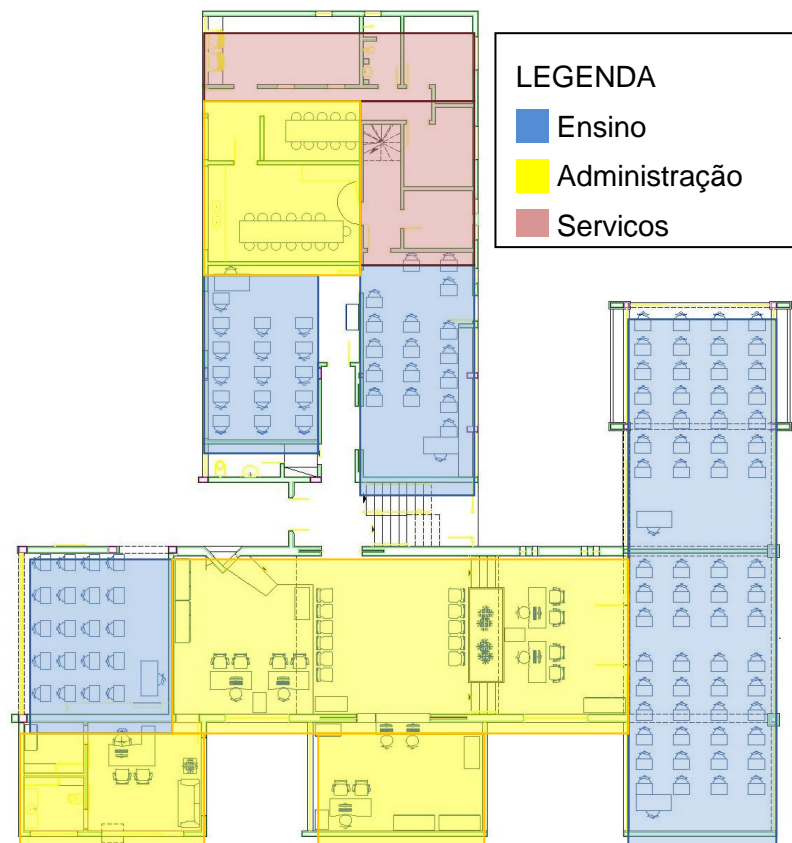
Planta Baixa Térreo. Fonte: Projeto Arquitetônico.
